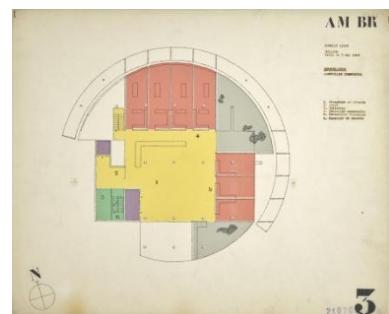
Projeto para a embaixada de França, Brasília, 1964-5 (Planta)
